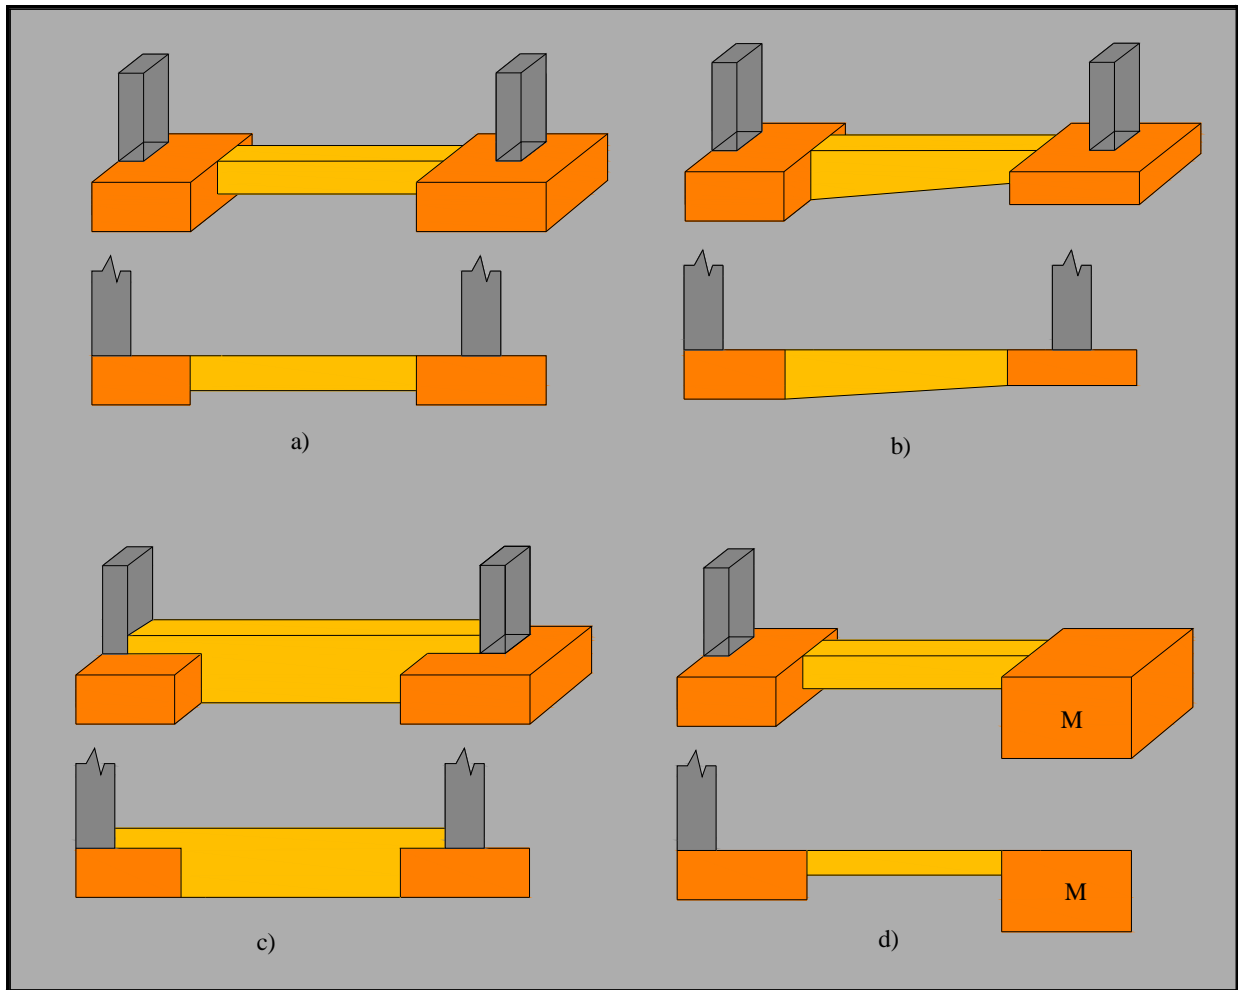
Zapata de medianería conectada con una viga centradora.
